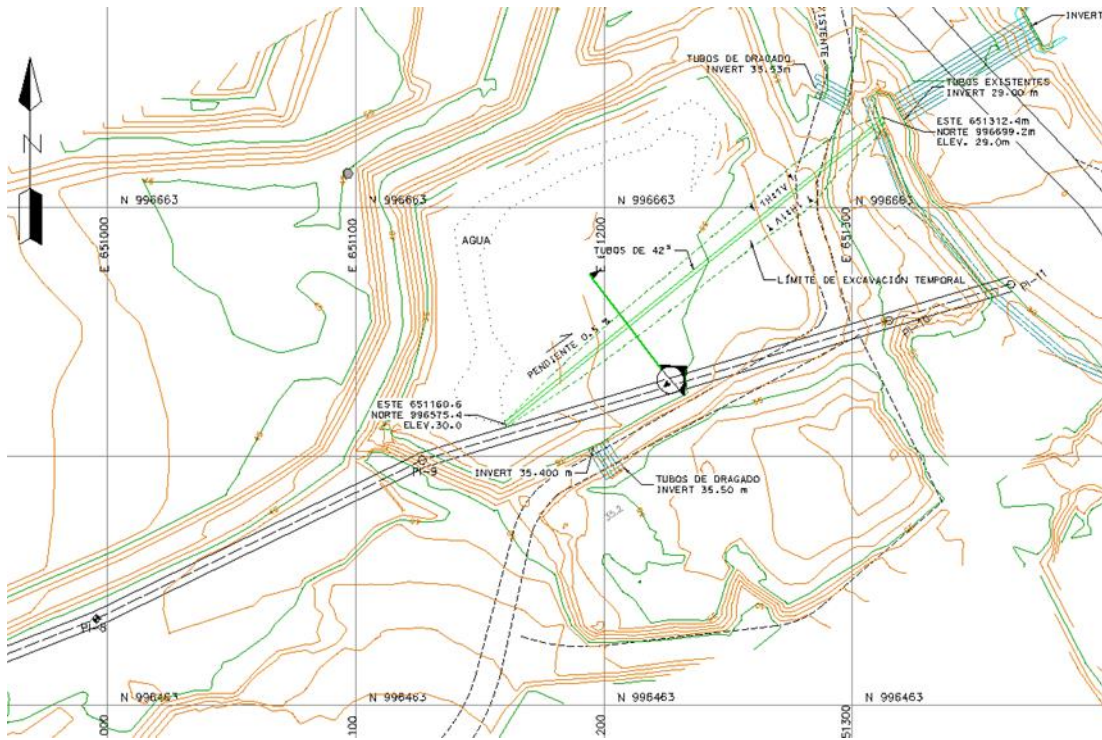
Planta del alineamiento horizontal del drenaje construido
